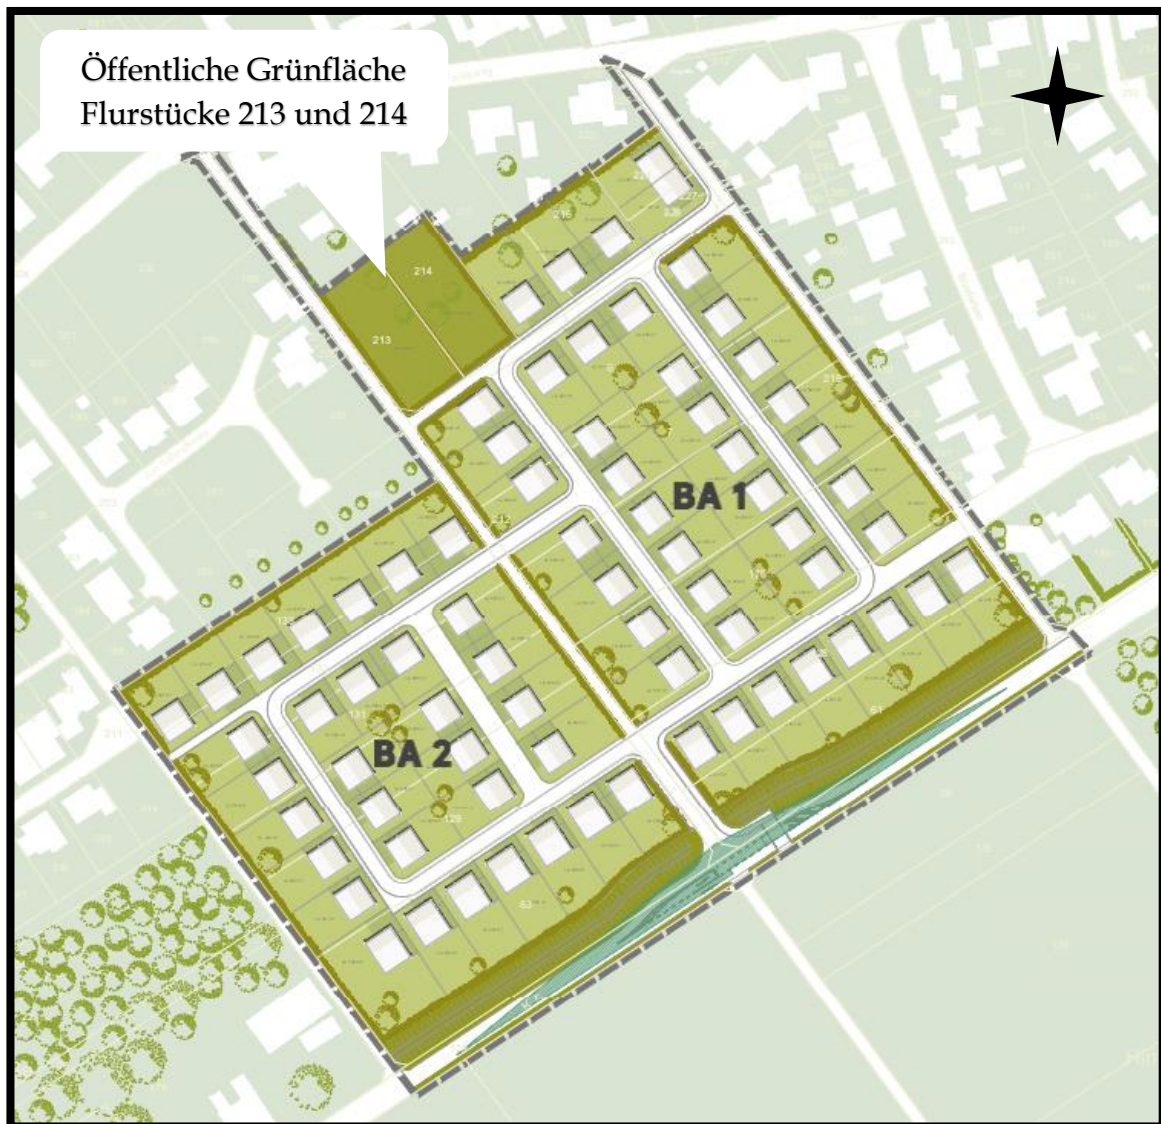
Geplantes Vorhaben, Grundriss (Quelle: VDH Projektmanagement GmbH)
